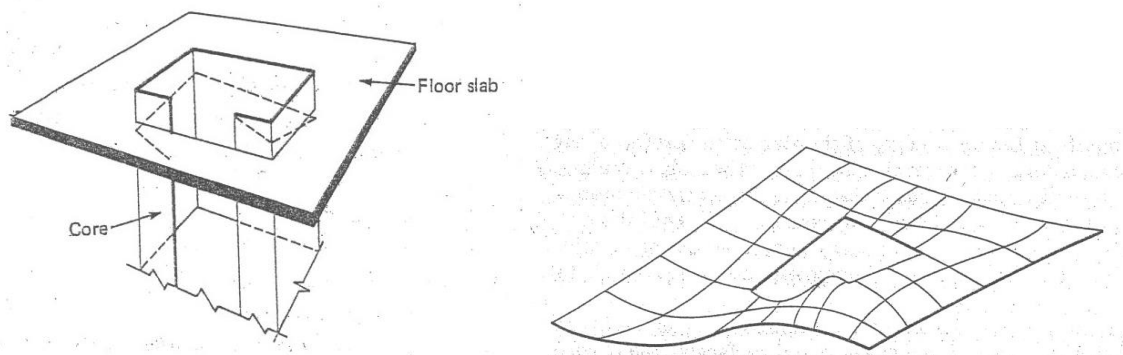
Ingobbamento dell'anima centrale della struttura e della lastra di piano.
